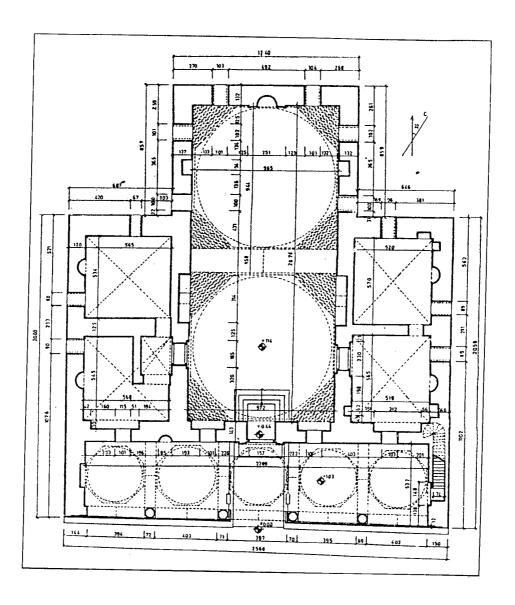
مسقط أفقي لمسجد المرادية في أدرنة (عن كوران) .
